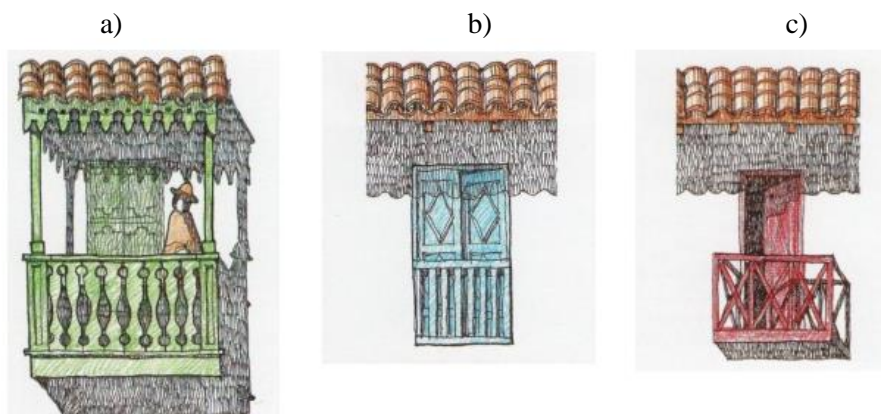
Tipología de balcones a) balcón elaborado con lambrequines arriba b) balcón sencillo al ras de fachada c) balcón ligeramente sobresalido.
